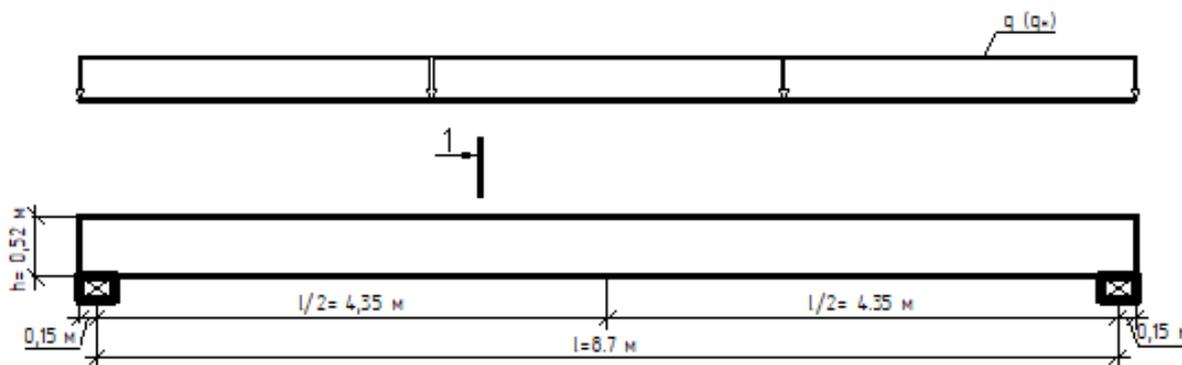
Расчетная схема усиливаемой клееной деревянной балки
